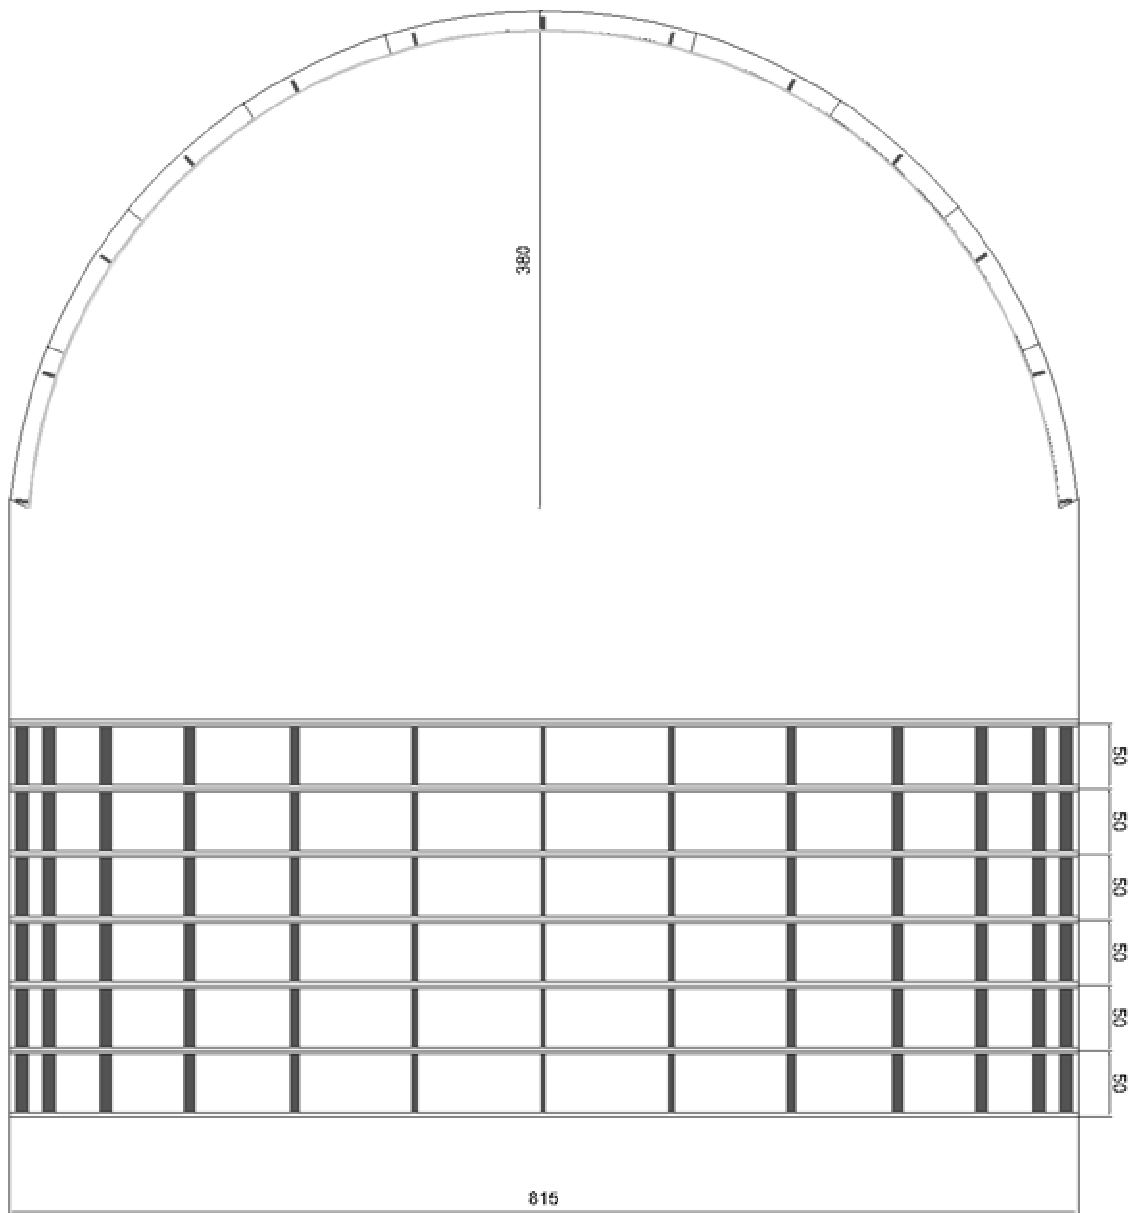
Sezione trasversale della volta in camorcanna e prospetto dall'alto
